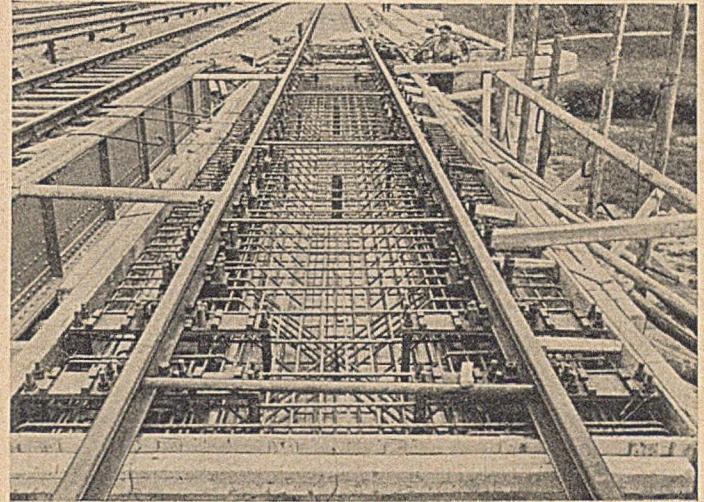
Versuchsbrücke in Verbundbauweise. Uferstraße Göttingen, km 246,386, Bebra—Göttingen. Hier: Druckplattenbewehrung und verlegtes Gleis vor dem Betonieren der Platte.
